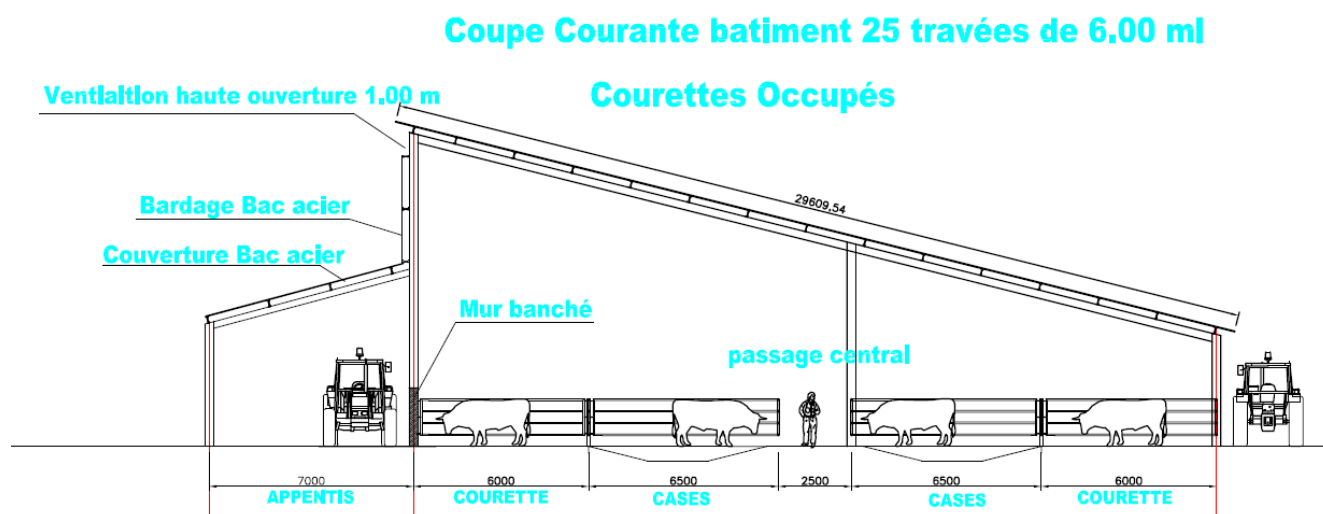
Extrait des plans des bâtiments du permis de construire (coupe courante)
